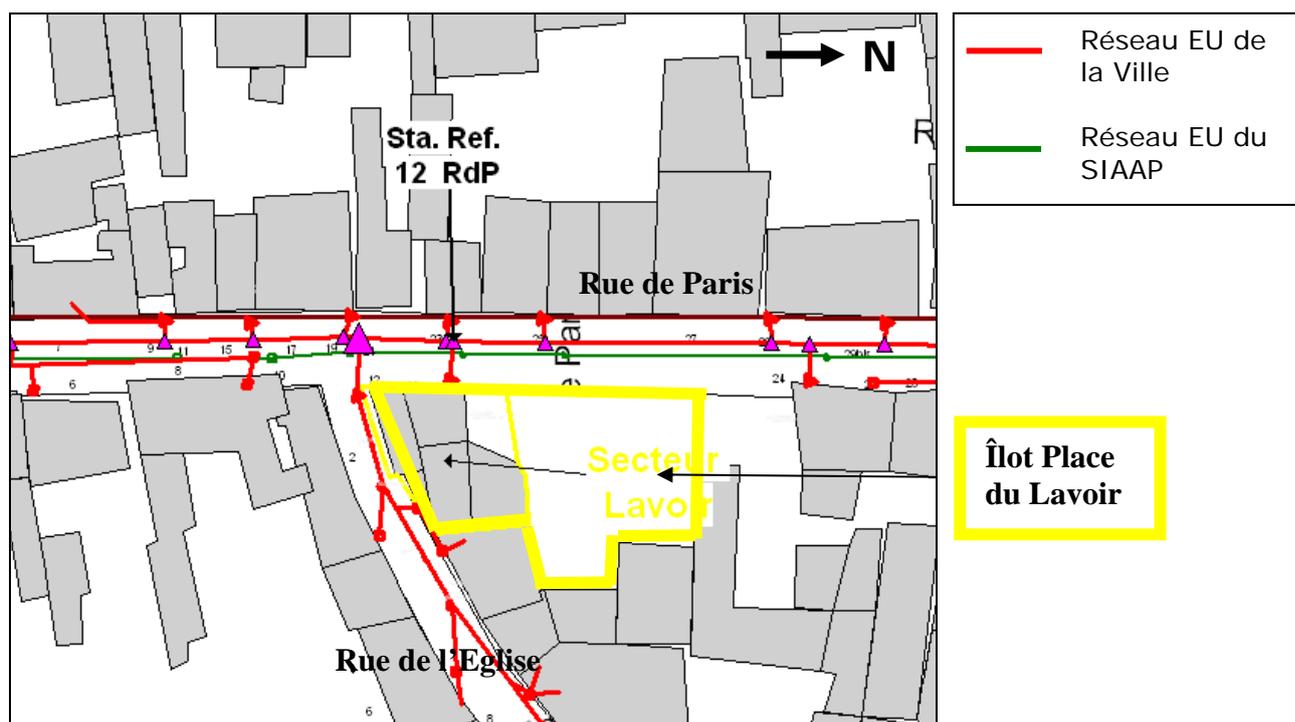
Réseaux d'eaux usées existant du secteur Place du Lavoir
